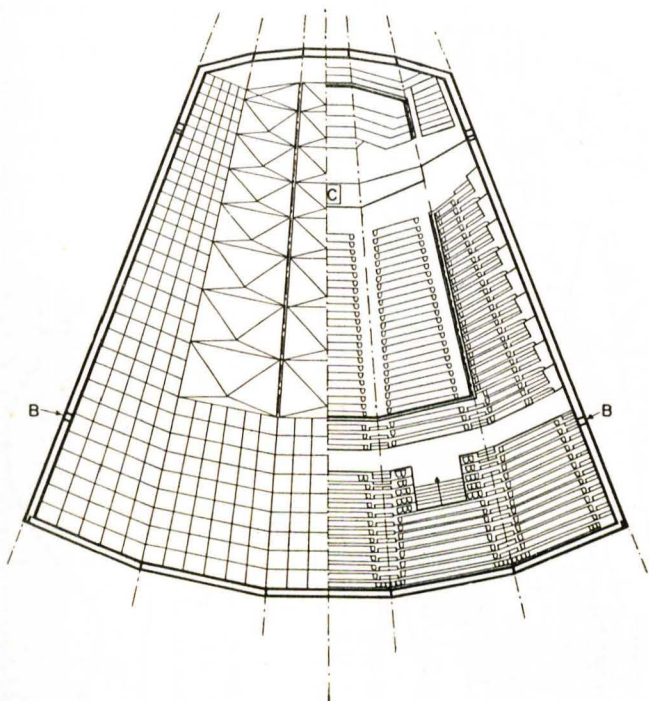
Grundriß des Saals mit Untenansicht der Decke im Halbschnitt.
